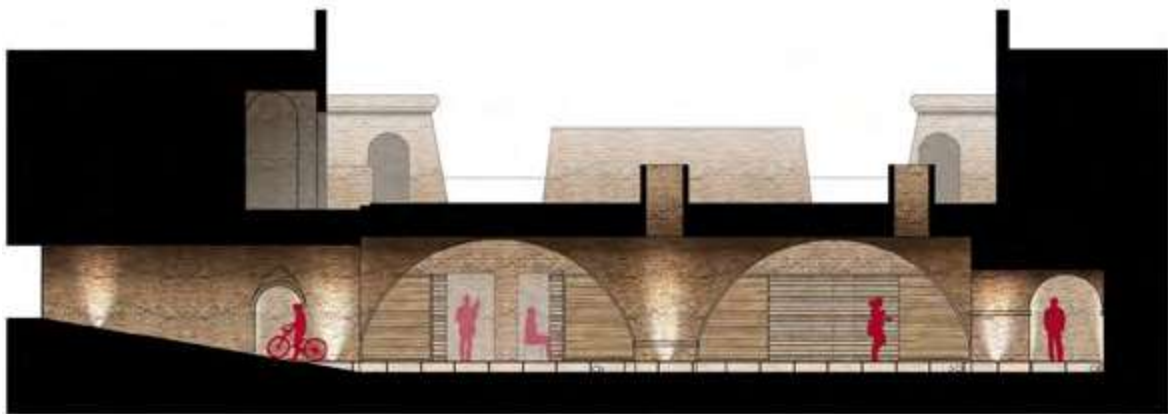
Sezione lungo un attraversamento tipo, con l'accesso alle attività interne alle troniere.
